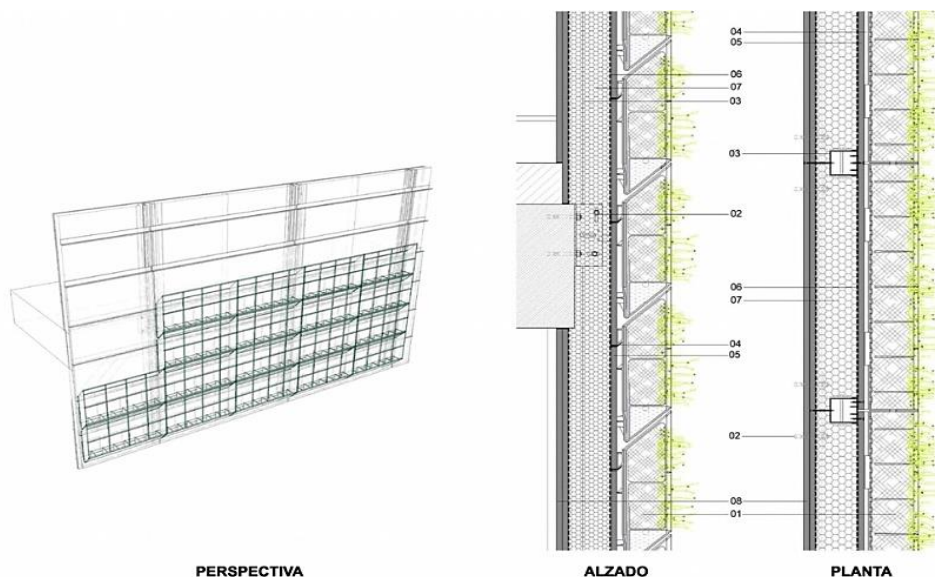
Esquema de la Fachada de enrejados modular. Fuente: Signare.es
